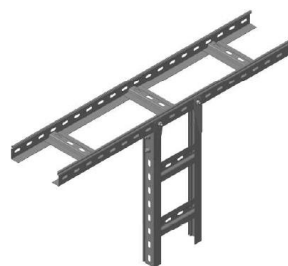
Пример опуска лотка при помощи соединителя поворотного
